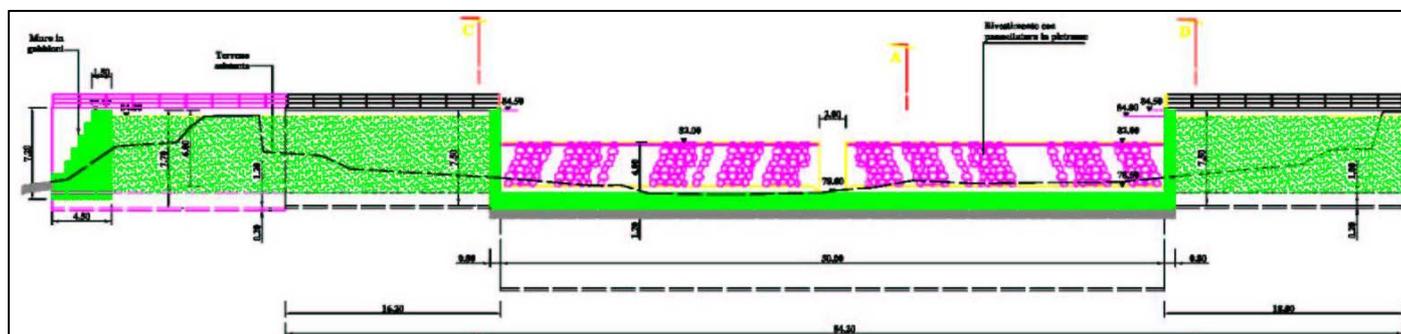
Sezione longitudinale briglia sul Torrente Ombrone.
